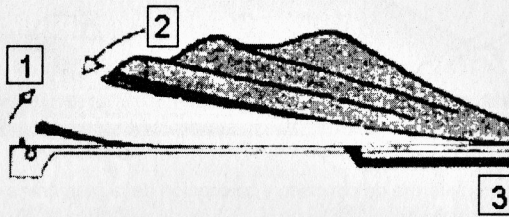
(1) Retiro del tubo de PVC de la cimentación, (2) colocación de la membrana de neopreno, (3) ducto para suministrar el aire.
